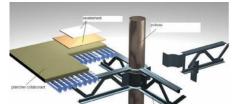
Détail Plancher Collaborant source (http://www.guidebeton.com/plancher-collaborant s.d.)
